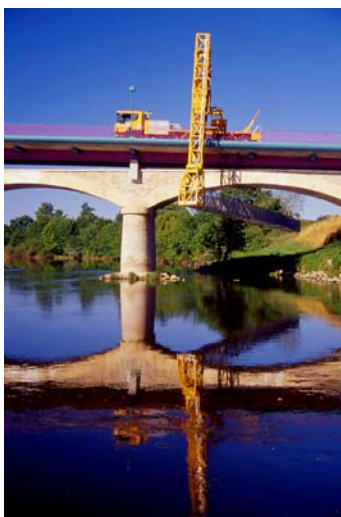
Passerelle négative pour l'examen des intrados d'ouvrages, des têtes d'appui et des appareils d'appui. Ici nous sommes dans le cas d'une structure en maçonnerie recouverte d'une dalle générale.
